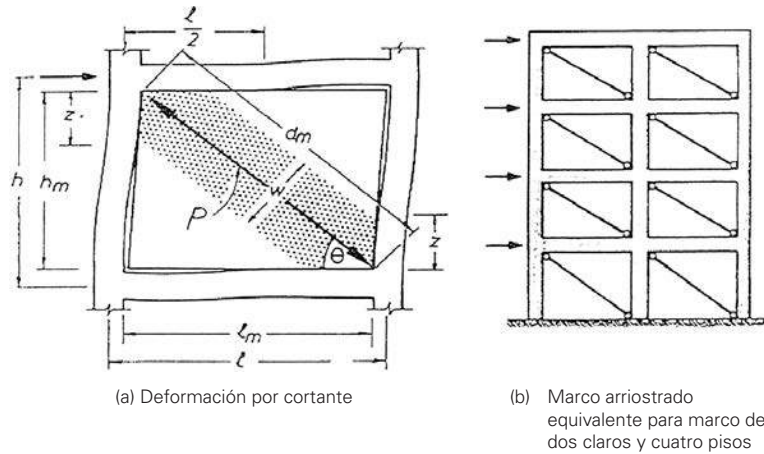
Puntal de muro de marco relleno de mampostería (Paulay, T., y Priestley, N., 1992).
